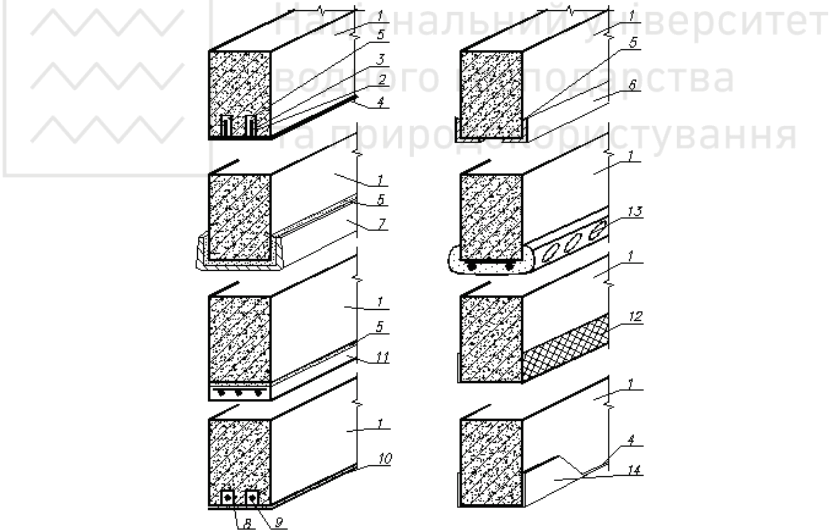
Підсилення залізобетонних балок зовнішнім армуванням:
